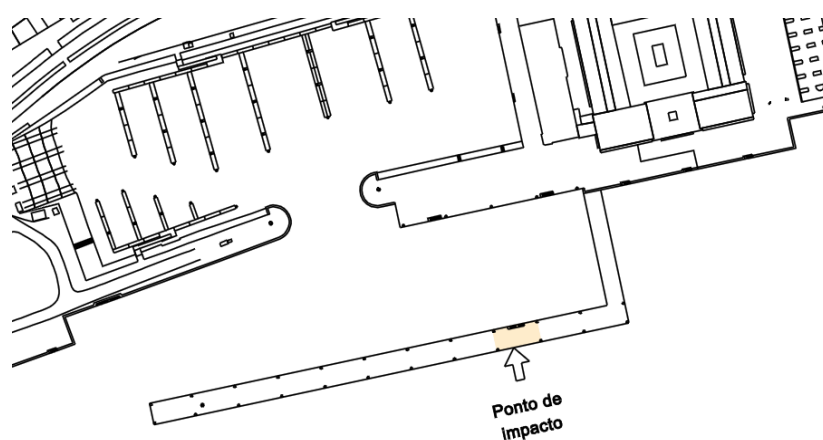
Planta geral do molhe de abrigo com indicação da zona afectada no acidente.
